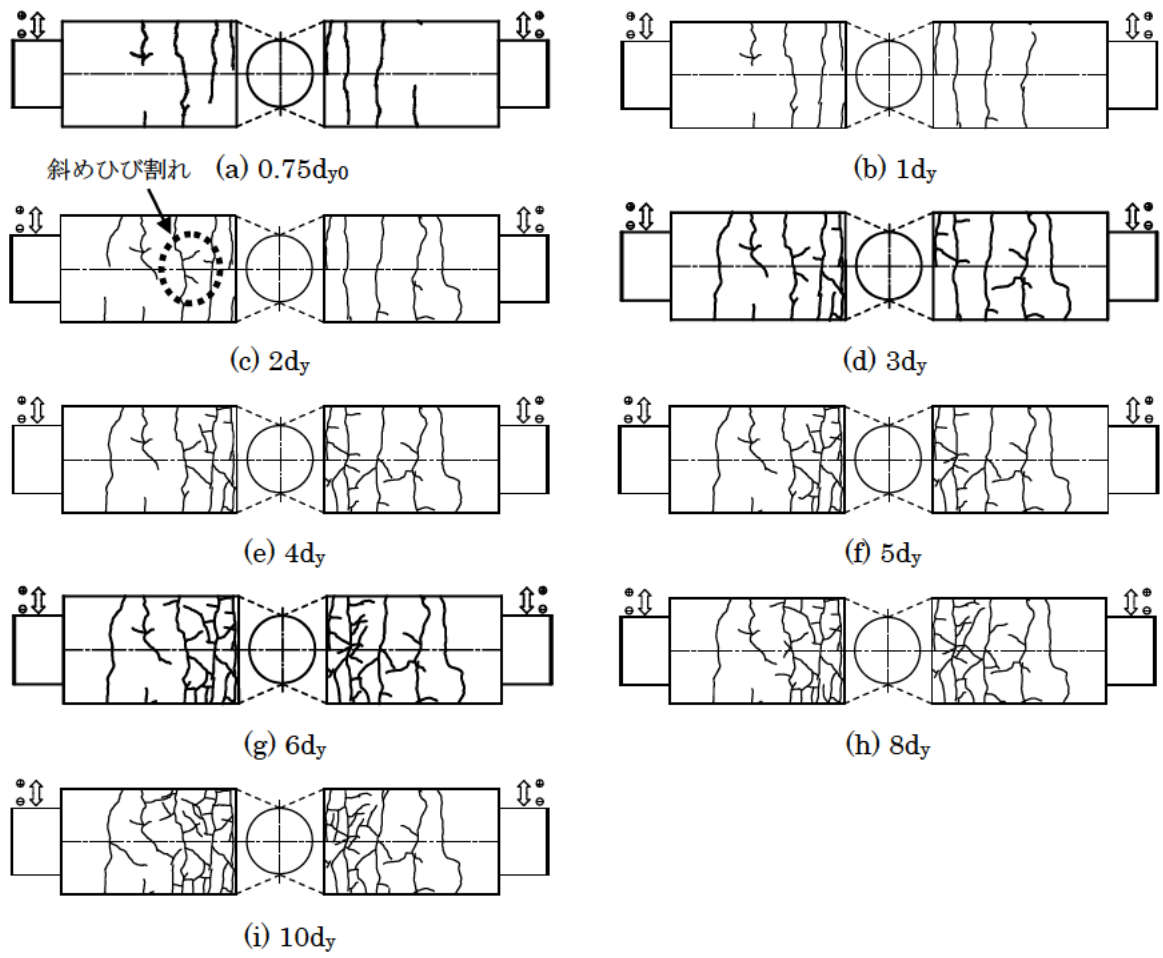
杭体のひび割れ進行状況図 (Case CPP-S-3)
